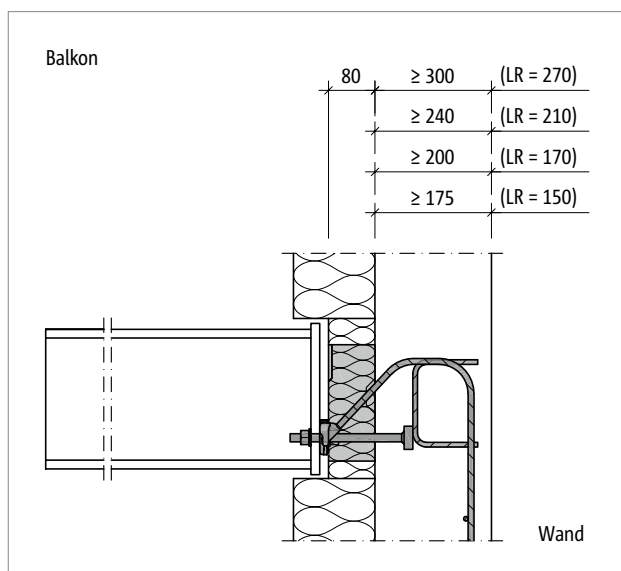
Schöck Isokorb® T type SQ: aansluiting op gevelisolatie met behulp van een nok aan de vloer, rekening houdend met de randafstanden ten aanzien van de minimaal vereiste betondekking
